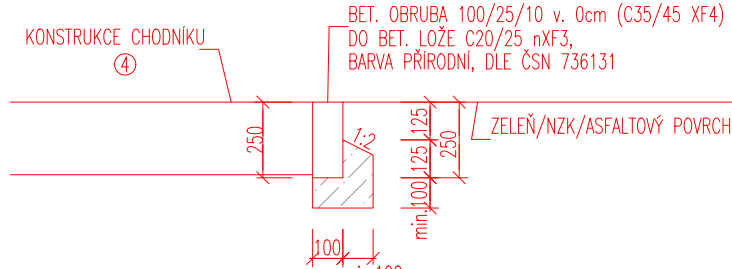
DETAIL ULOŽENÍ SILNIČNÍ BETONOVÉ OBRUBY BO 100/30/15
